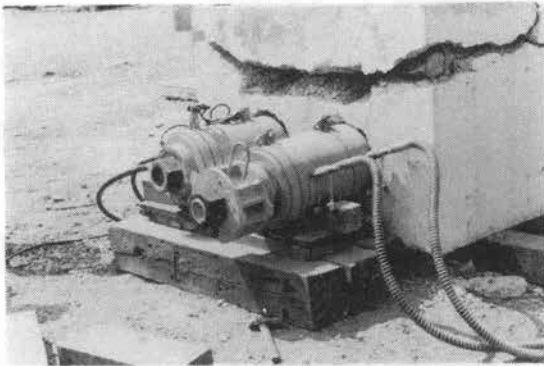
引込式コンクリート破壊機による破壊状況 (ジャッキ側)
